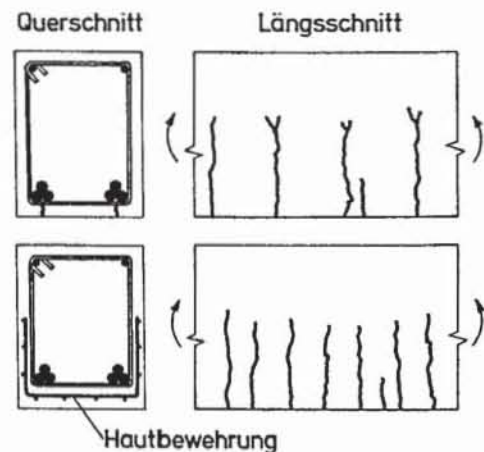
Rißbilder bei Verwendung von Stabbündeln mit und ohne Hautbewehrung
